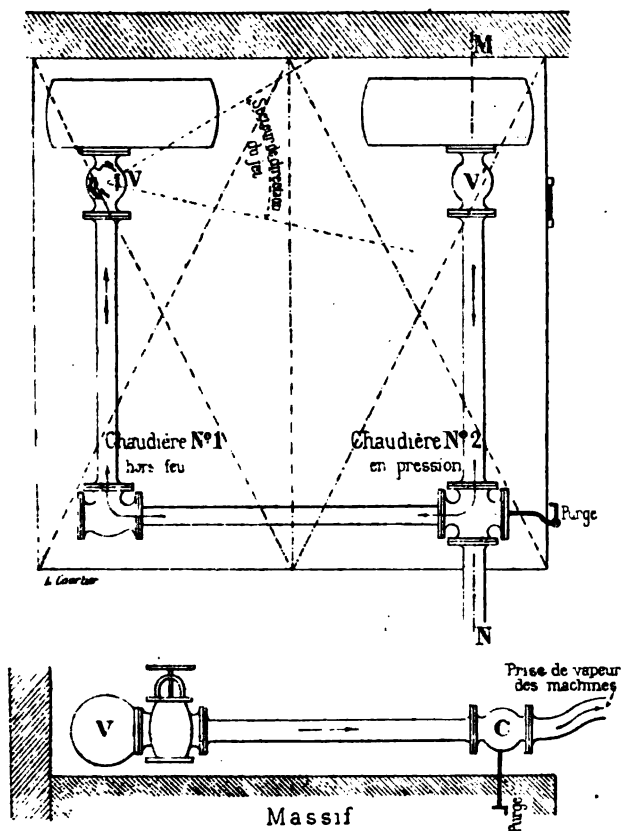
et 2. — Plan de l'installation, à Villefranche, et coupe suivant MN.
